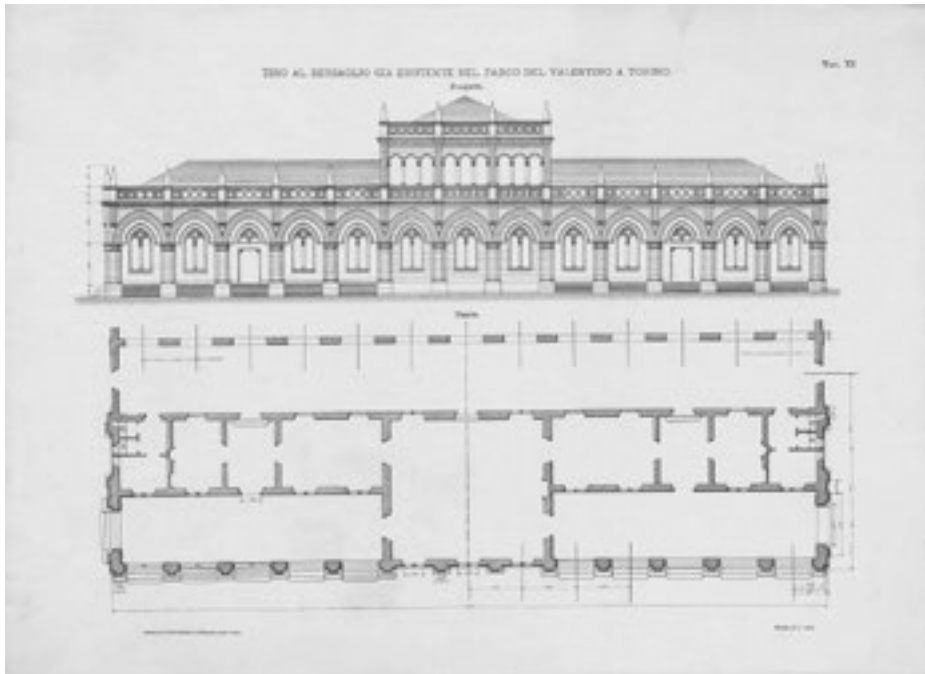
Tiro al Bersaglio già esistente nel Parco del Valentino a Torino. Prospetto e pianta (ASCT, Collezione Simeom, D 753, tav. XI).
